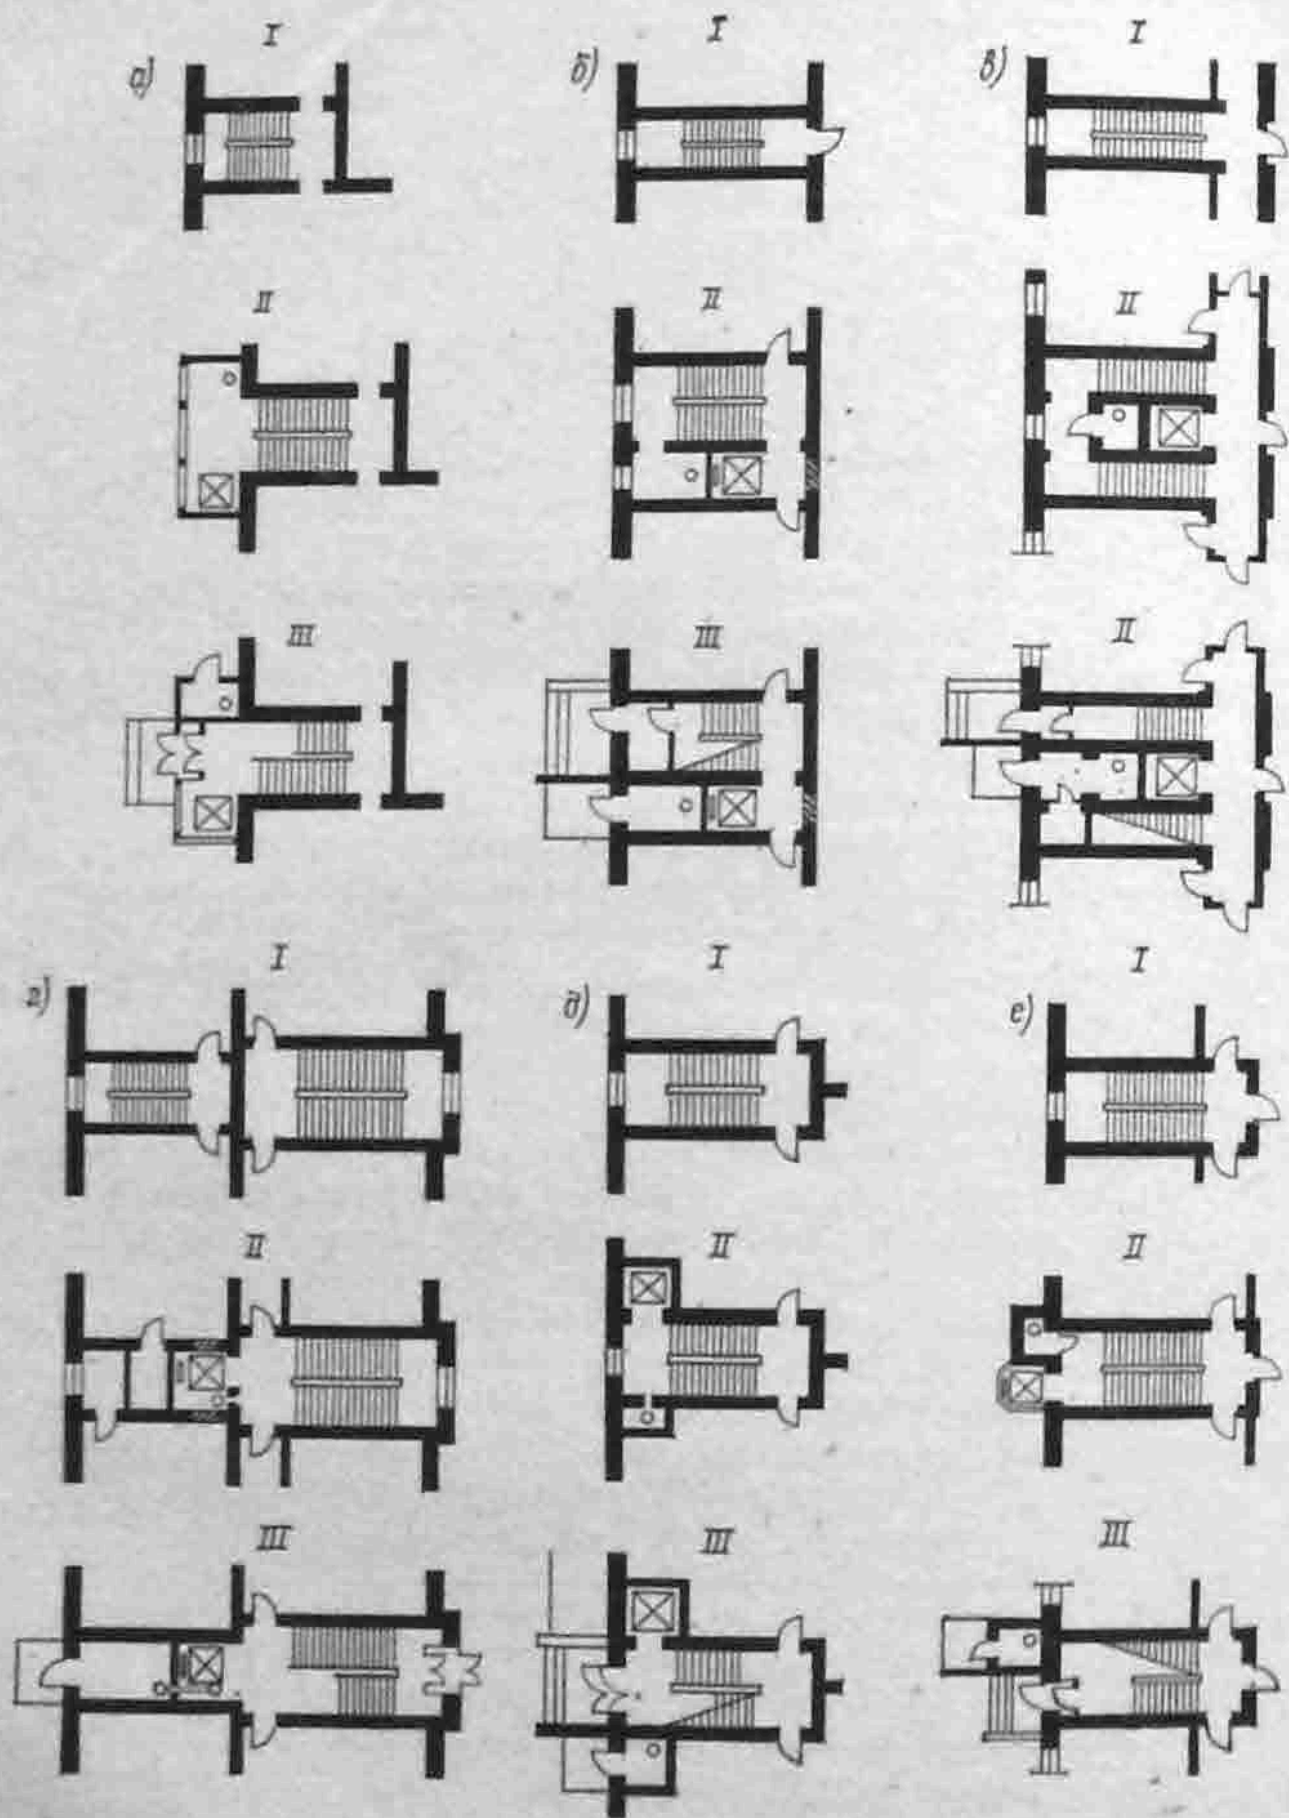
Реконструкция лестнично-лифтовых узлов:
